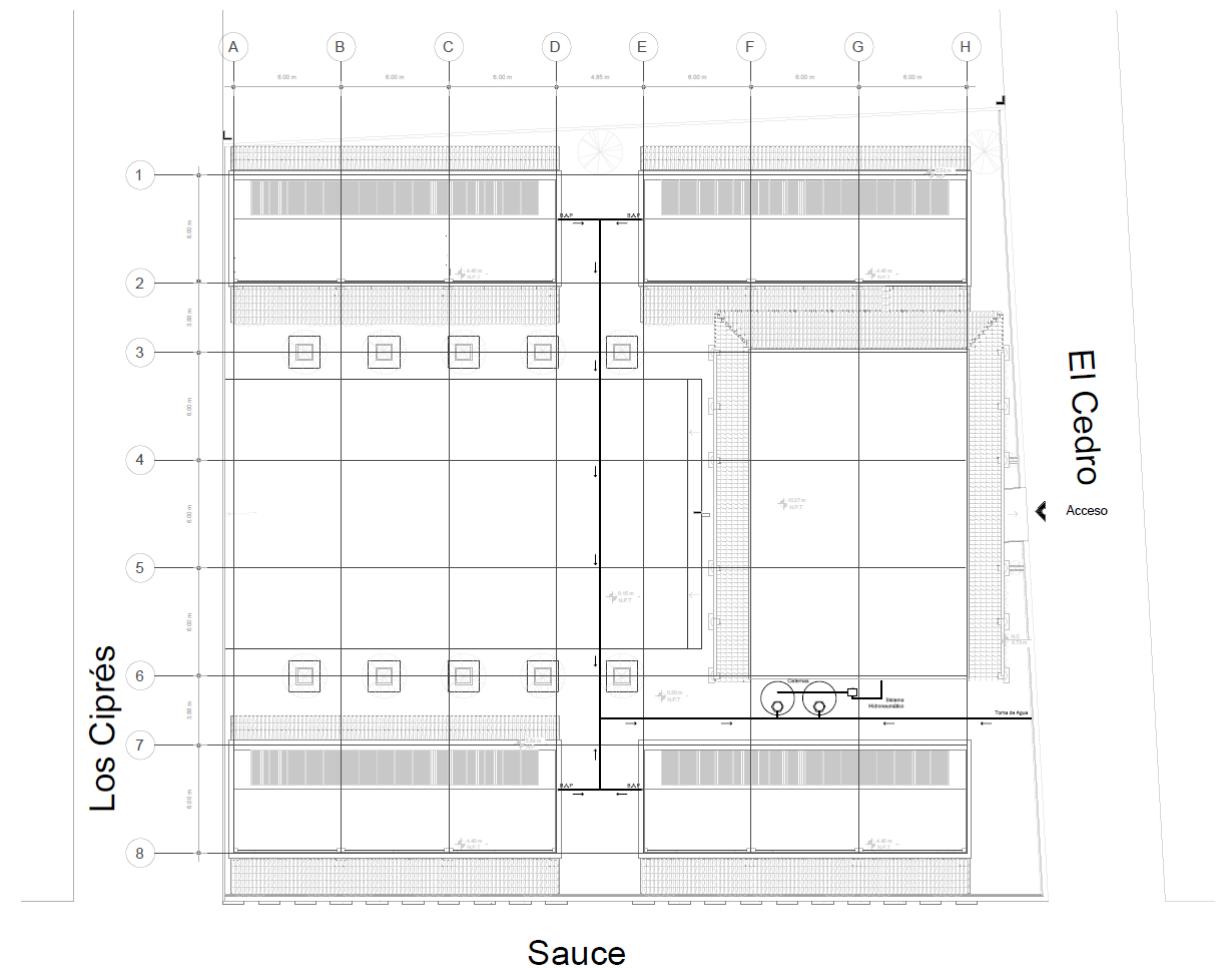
Instalación de Sistema de Captación Pluvial en Plano de Planta
